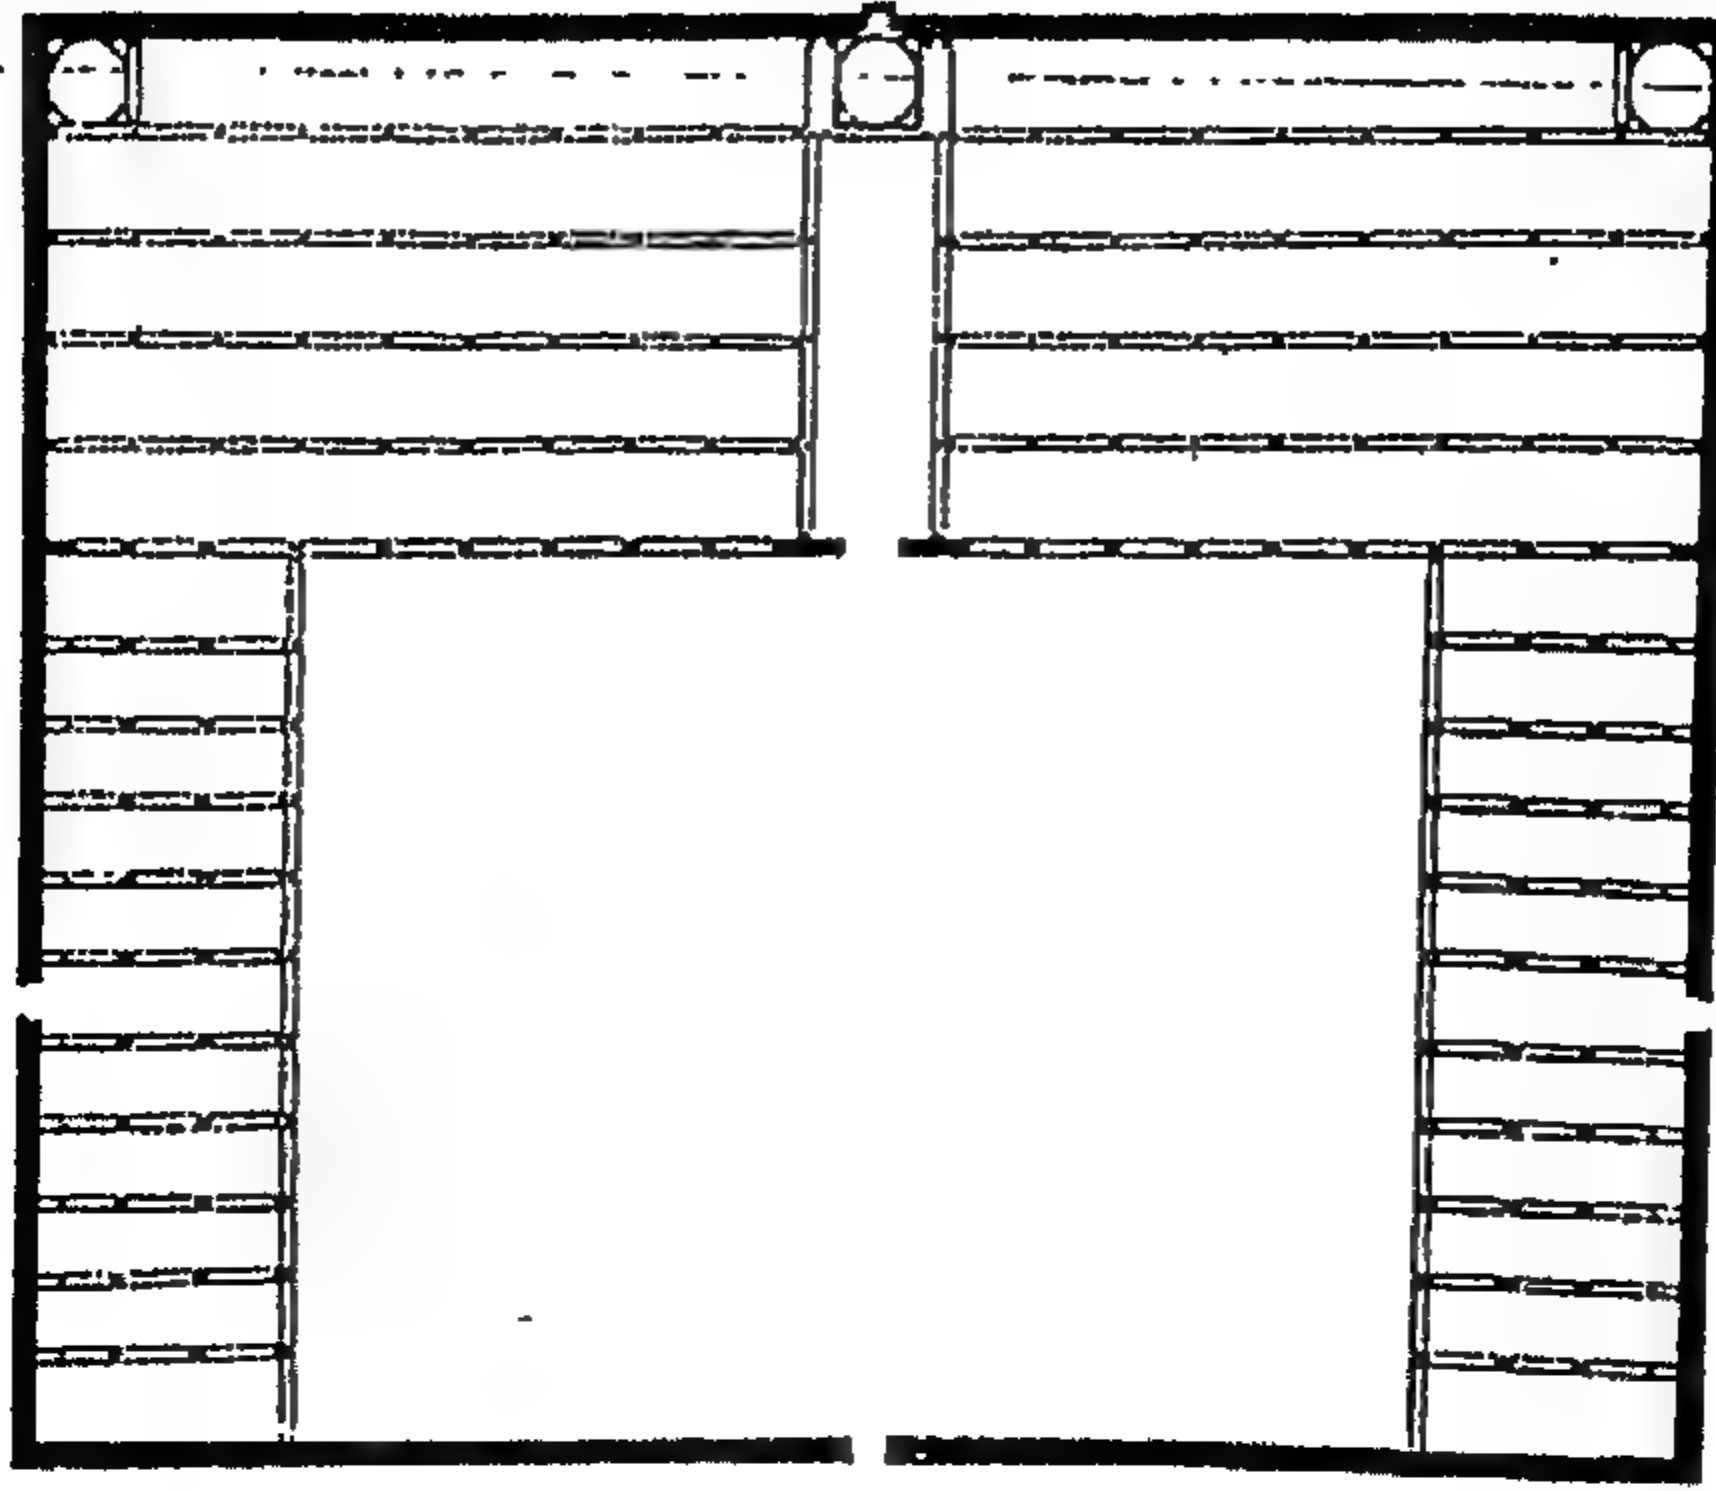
مسقط أفقي لمسجد القاضي يحيى زين الدين ببولاق بالقاهرة
